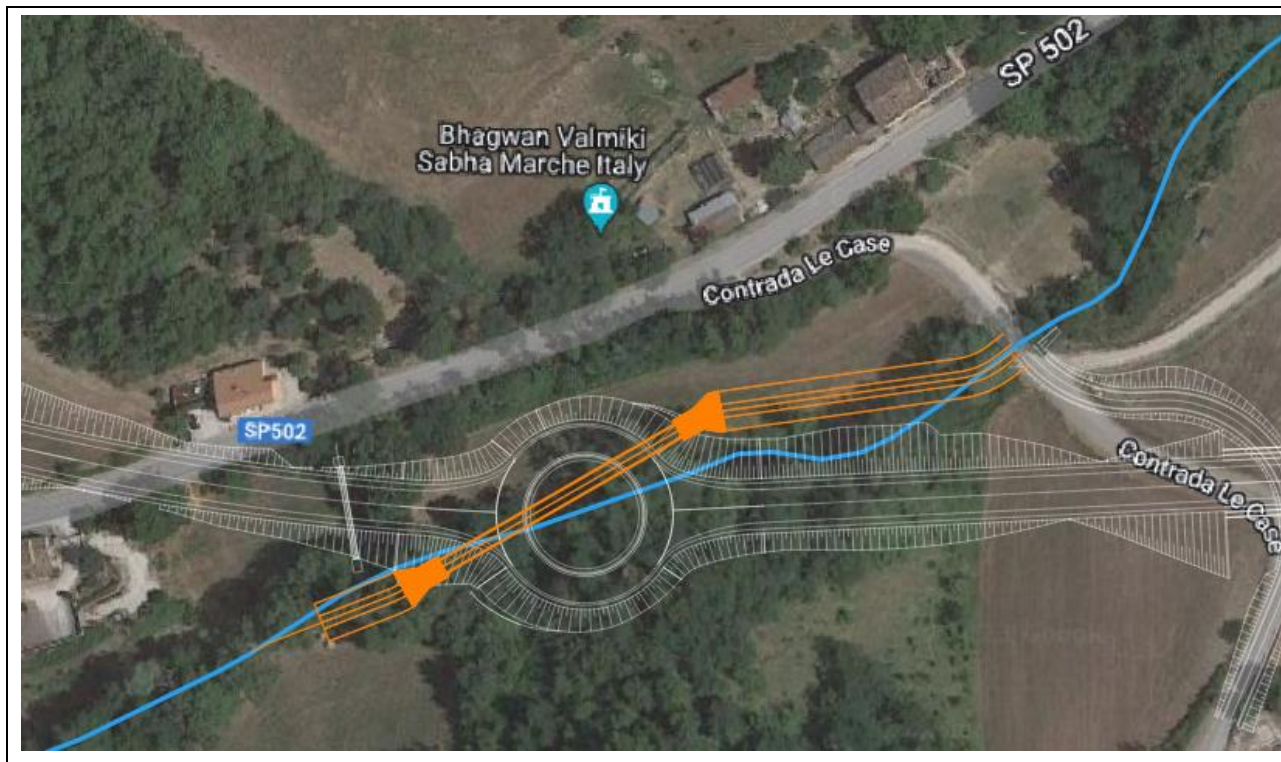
Interferenza infrastruttura stradale in progetto TM 02- inquadramento Planimetrico su ortofoto
